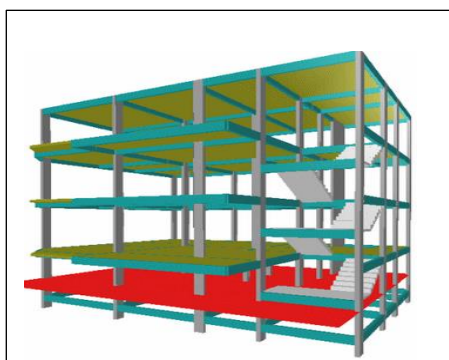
Modelo de edificação usando conceito de vigas de concreto armado.
